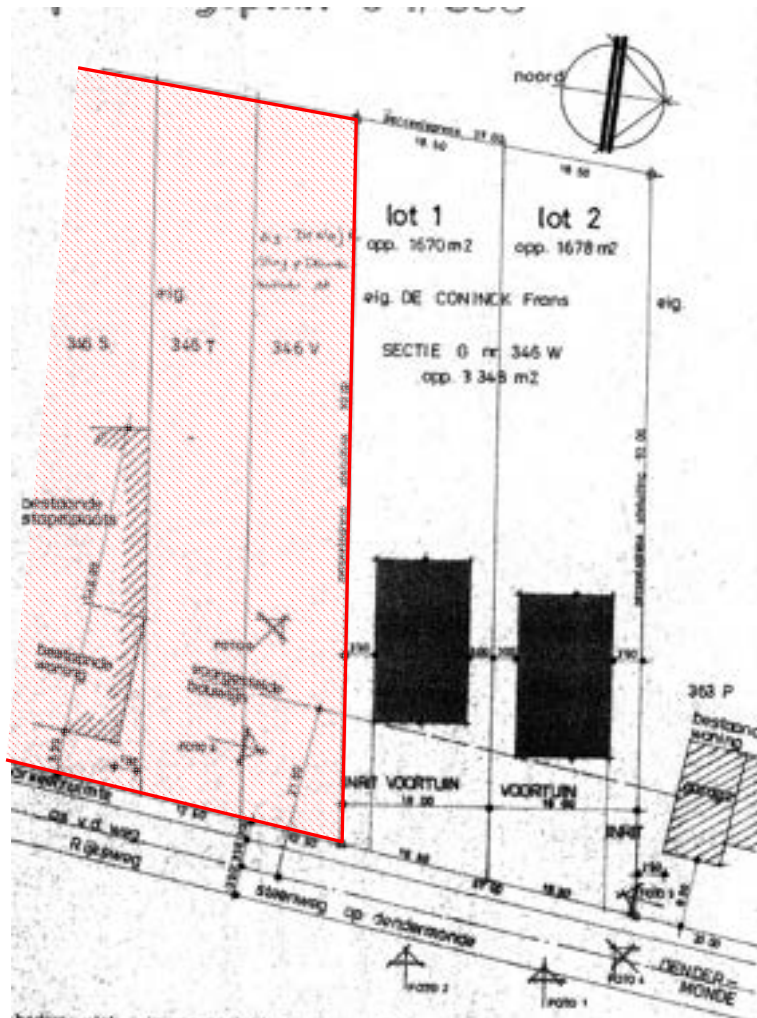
Uittreksel uit het Grafisch plan van het RUP landschappelijke overgang, bron gemeente Opwijk
